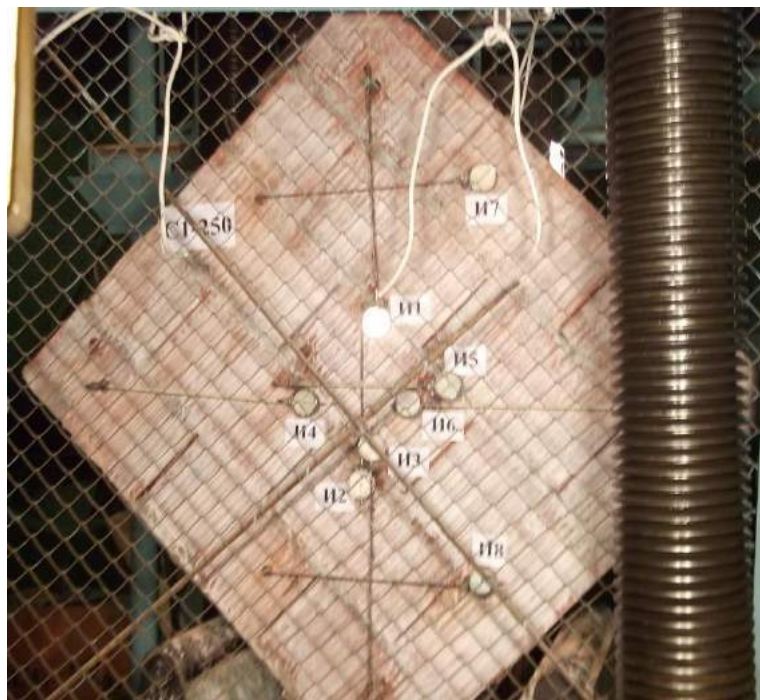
Образец из крупноформатного керамического камня Роготах-250 в прессе
